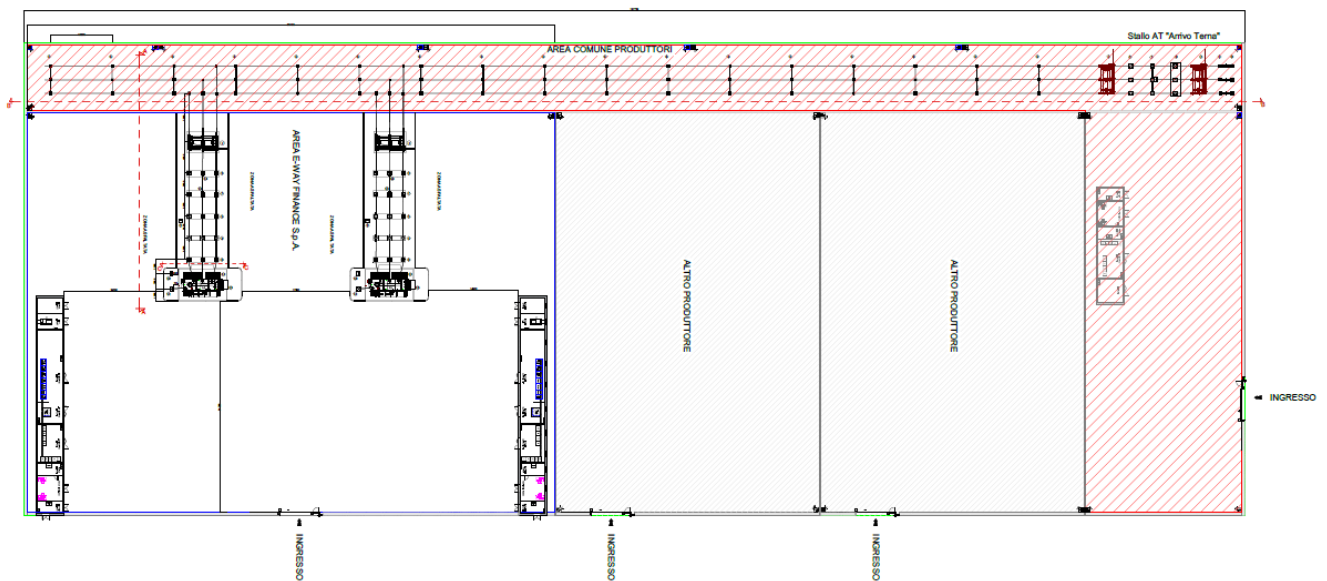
Planimetria Stazione di Trasformazione Utente 150/30 kV e Area Comune
